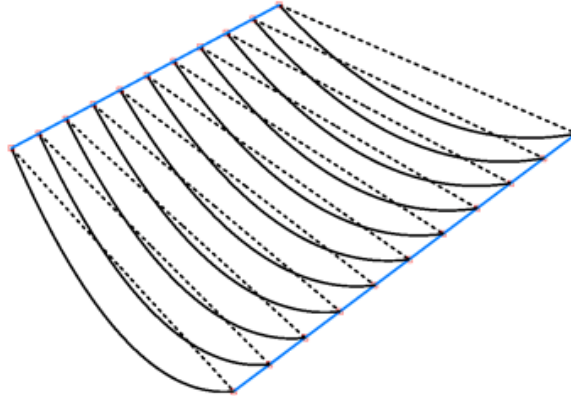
Trapezförmiger Grundriss mit aufgefächelter Zuggliedanordnung, Form (34)
